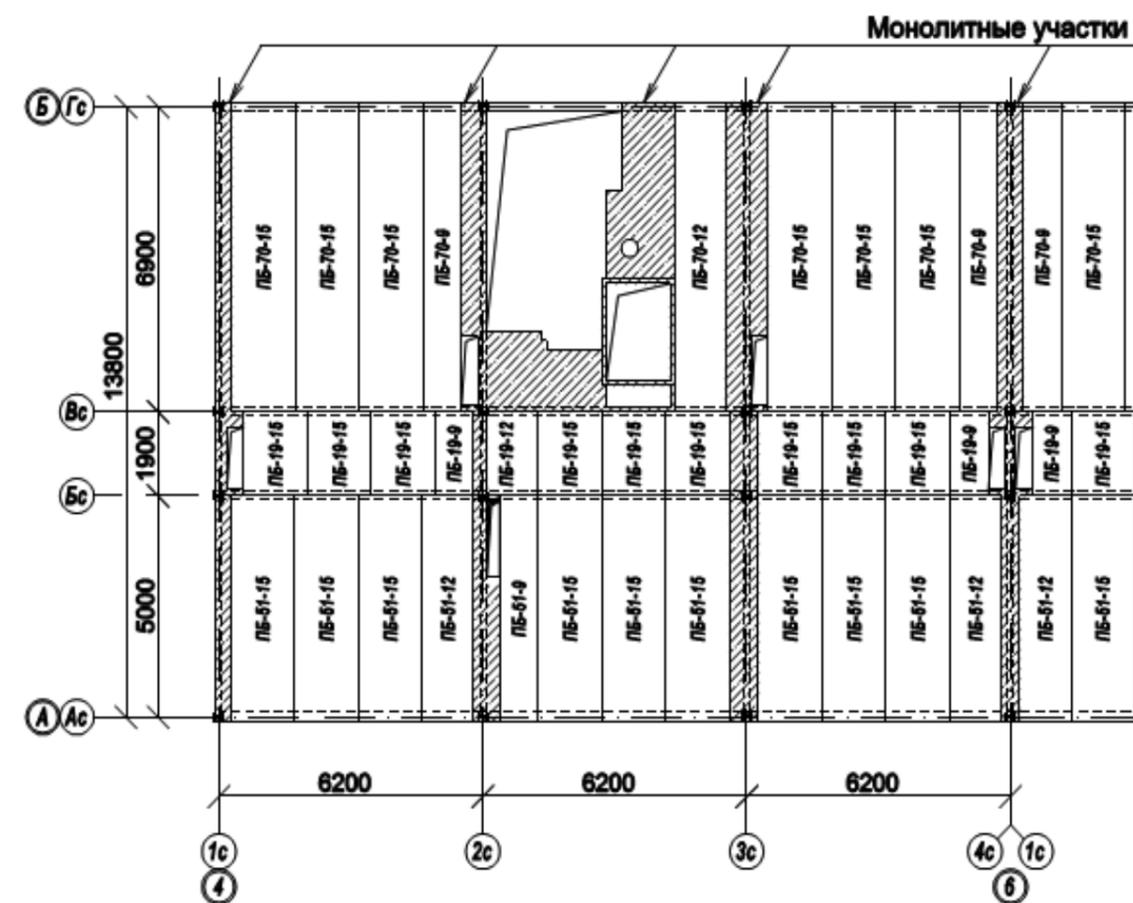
Фрагмент монтажного плана сборных плит перекрытия
